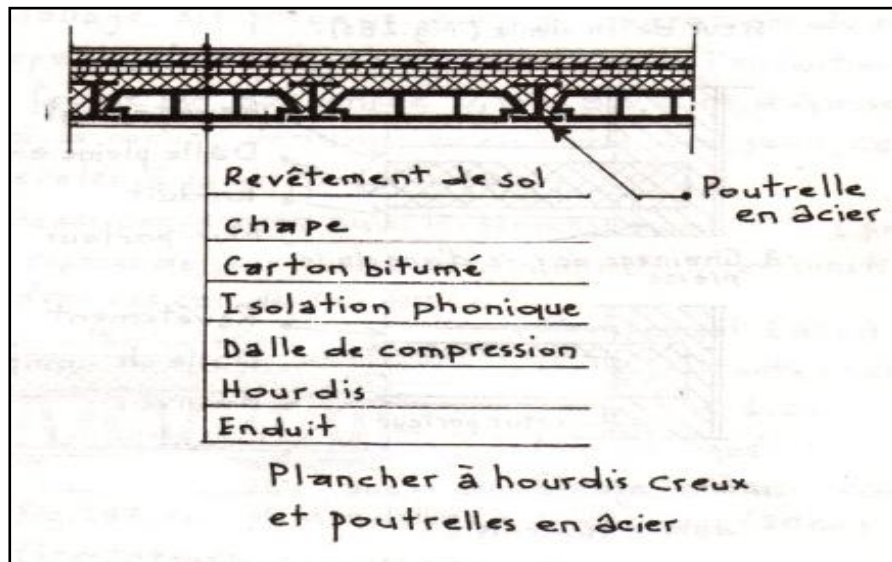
Plancher à Hourdis creux et poutrelle en acier.
